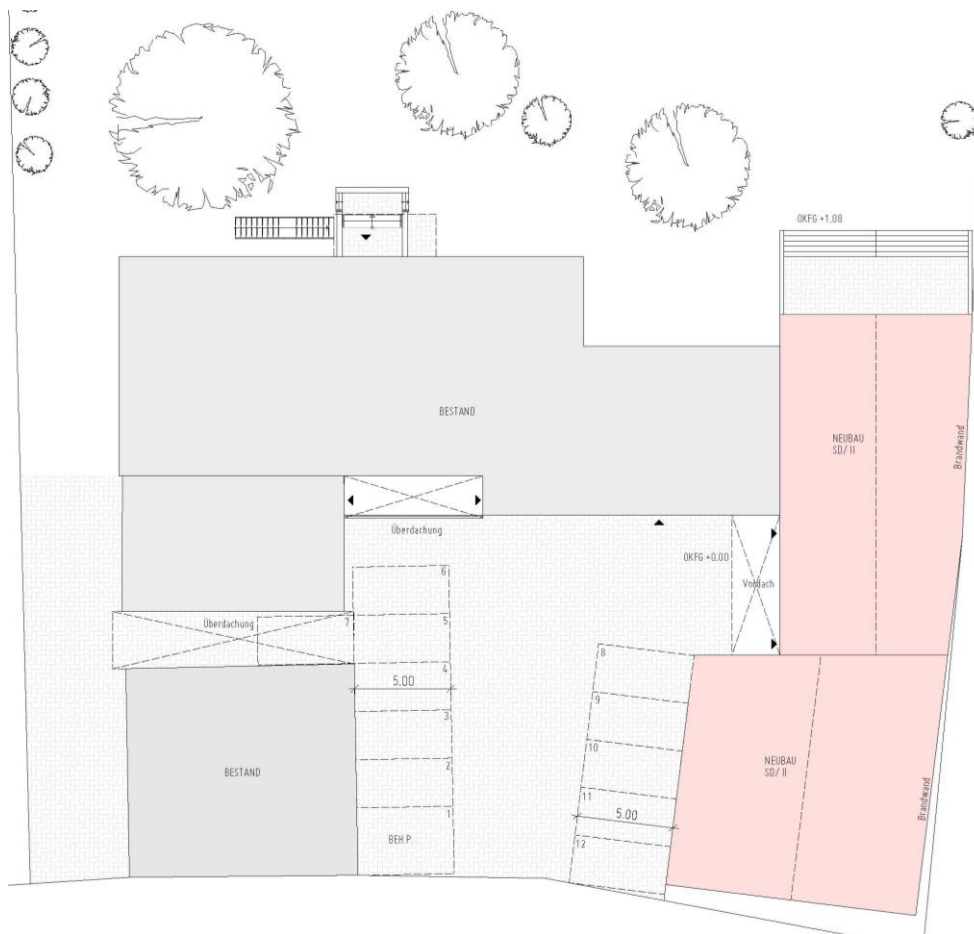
Lageplan der geplanten Erweiterung des Mehrgenerationenhauses.
